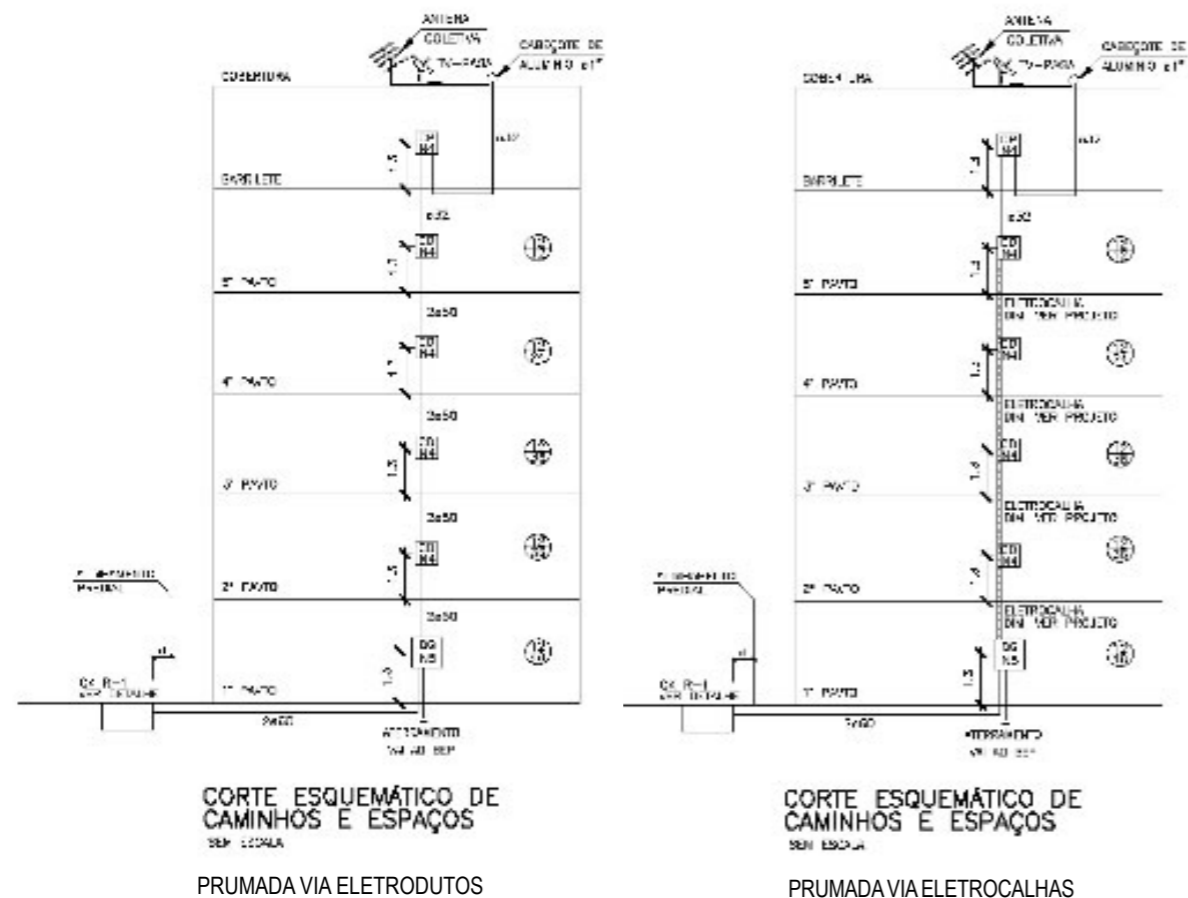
Exemplos de corte esquemático de infraestrutura em edificações verticais
